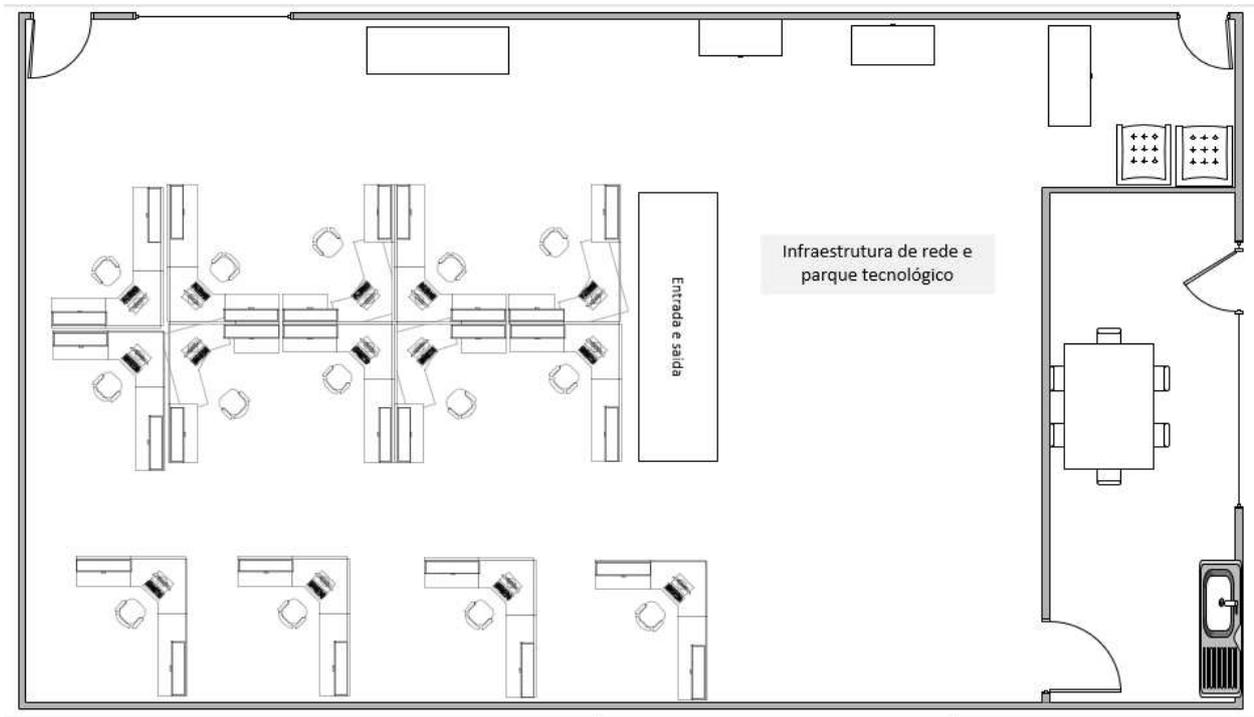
Planta Baixa Sala 1 – Infraestrutura de rede e parque tecnológico
